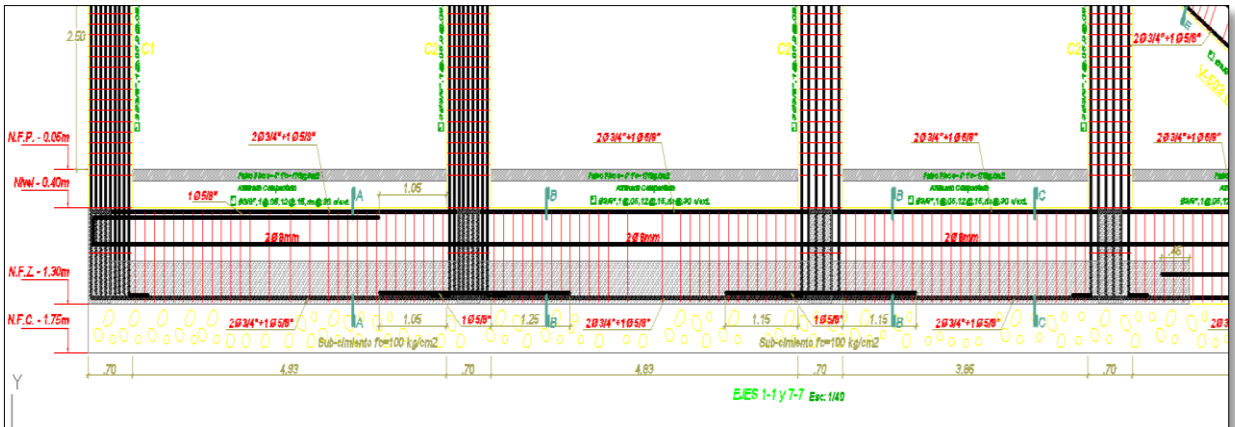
Detalle del Refuerzo de la viga T invertida.
